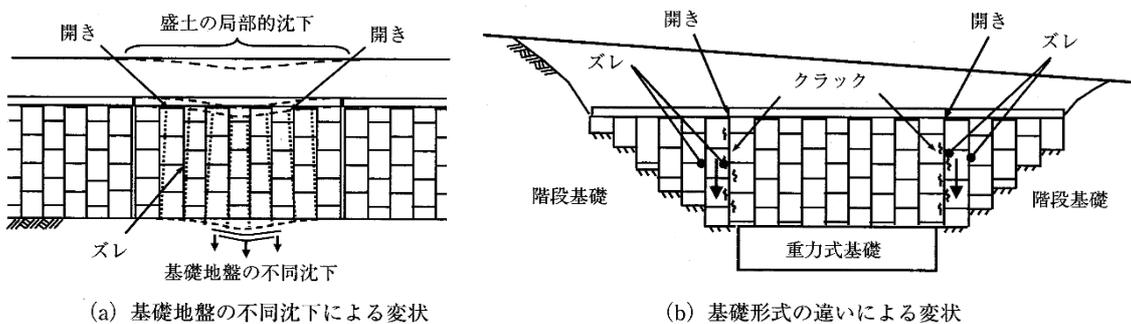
基礎地盤に起因する補強土壁の変形・変状事例⁸⁾
